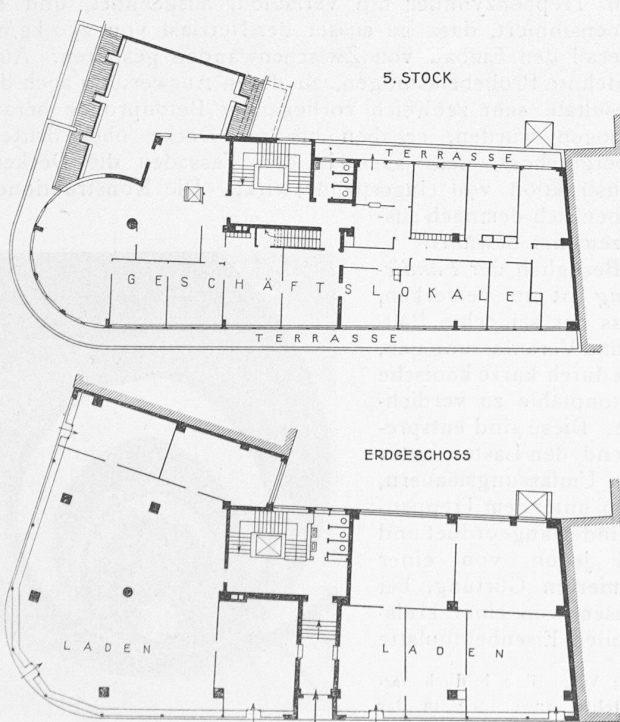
Geschäftshaus am Stauffacherquai, Zürich — Grundrisse 1 : 500.
